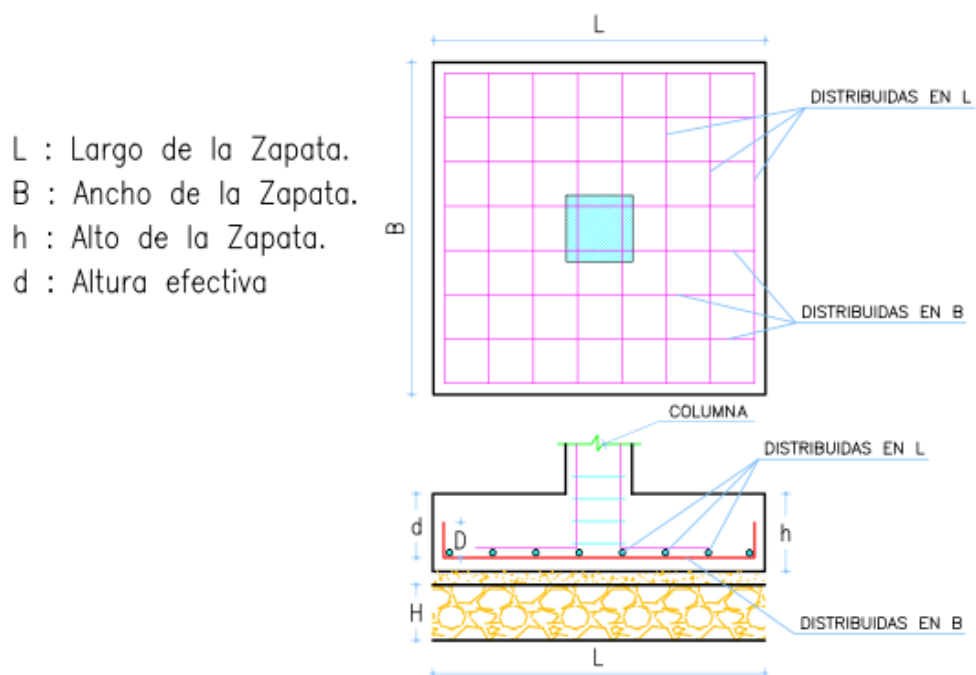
Detalle de acero para zapatas de Aula Multiservicio Fuente: Planos del Proyecto
